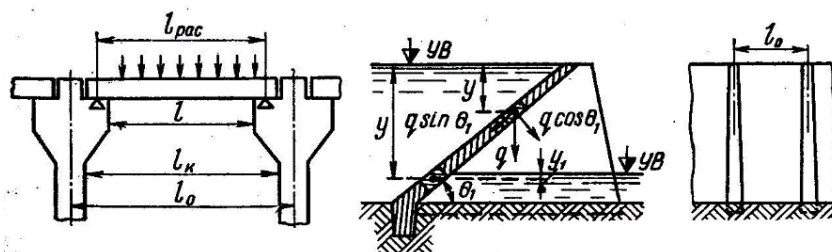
Схема к расчету плоских напорных перекрытий контрфорсных плотин
